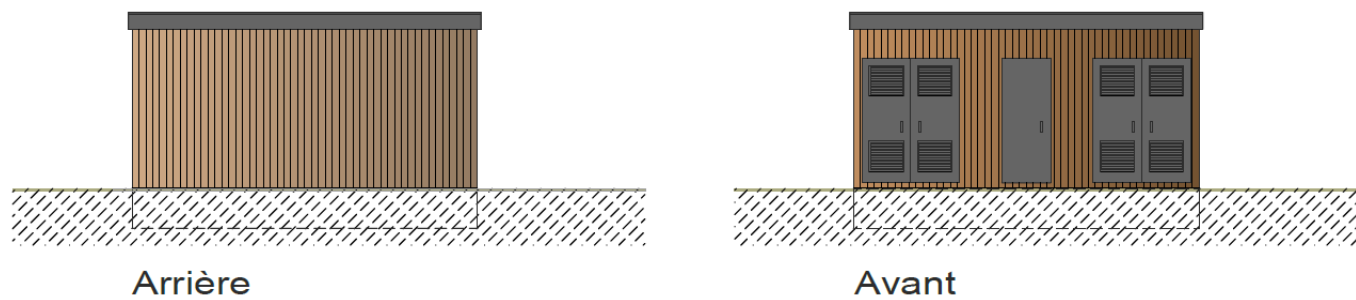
Vues des façades d'un poste transformateur prévu sur site
